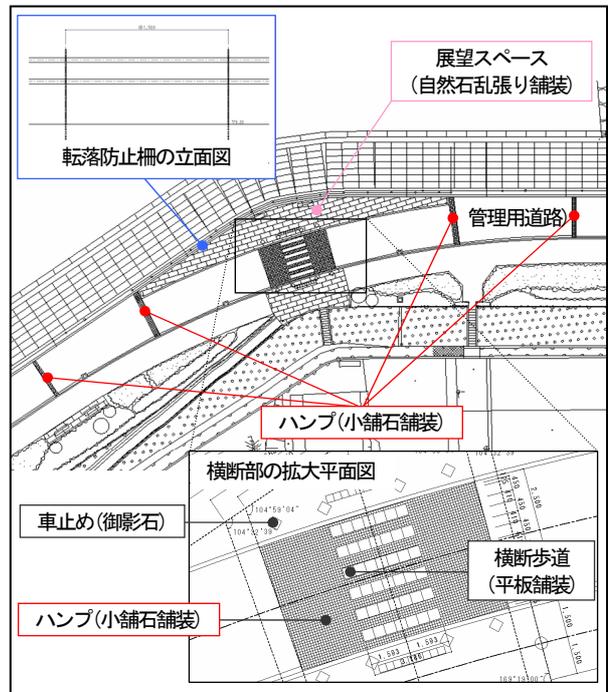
展望スペース周辺部（護岸屈曲部）の平面図
